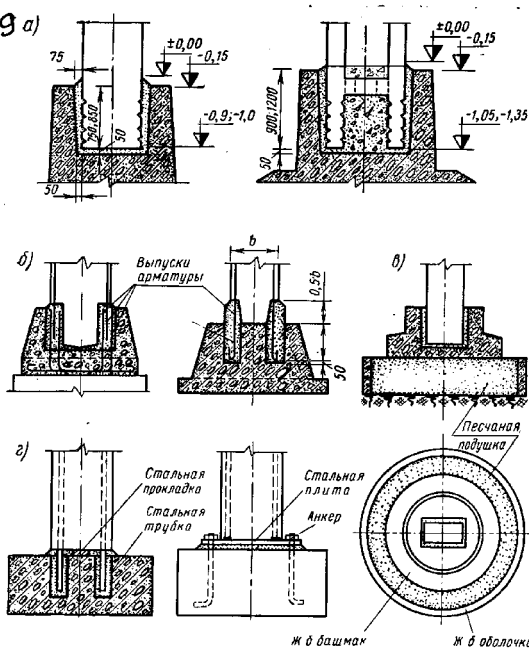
Стыки железобетонных колонн с фундаментами: а — посредством заполнения зазора бетоном; б — при помощи выпусков арматуры (ВНР); в — опирание башмака на песчаную подушку (Япония); г — стыки, применяемые в США
